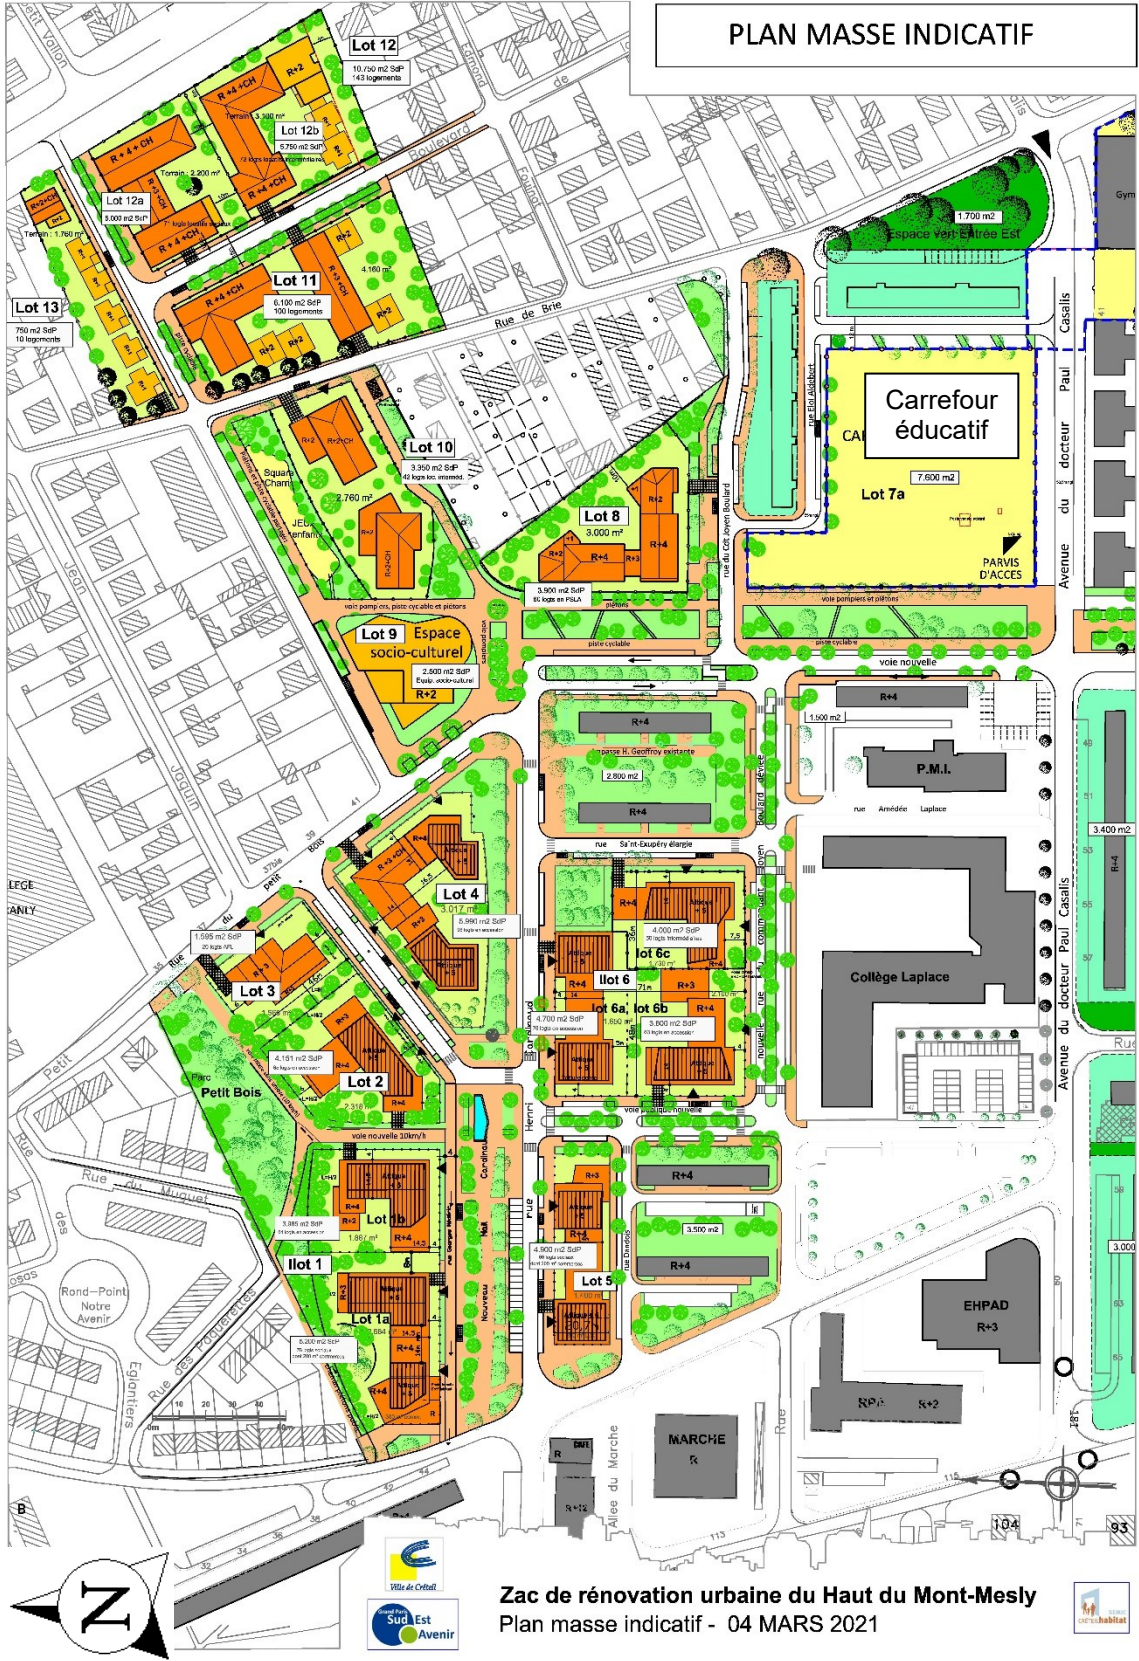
Plan masse indicatif du secteur Nord du Haut-Mont-Mesly
